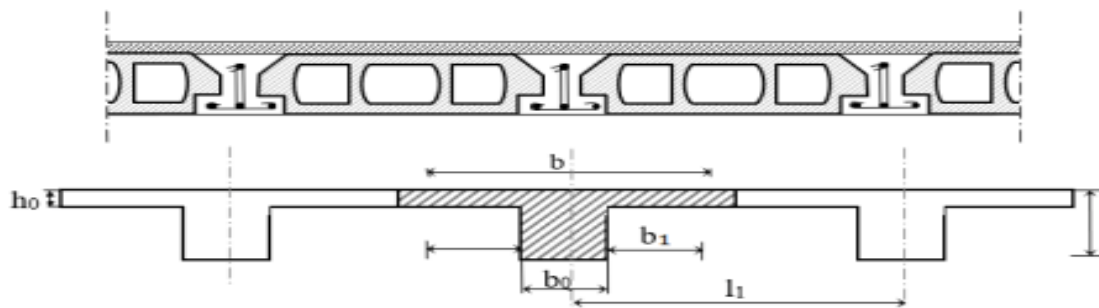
Coupe d'un plancher à corps creux et schéma explicatif de la poutrelle.
